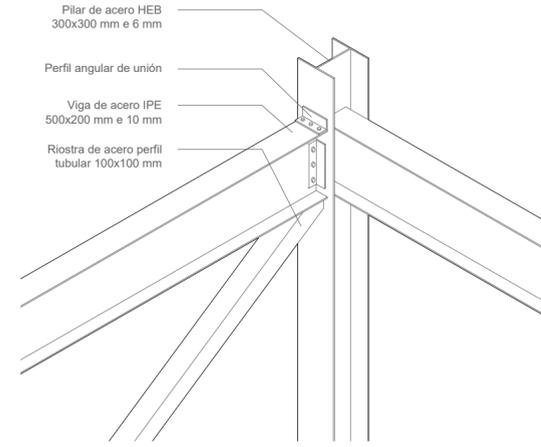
Unión entre pilar, viga y riostra. Fuente: Elaboración propia
